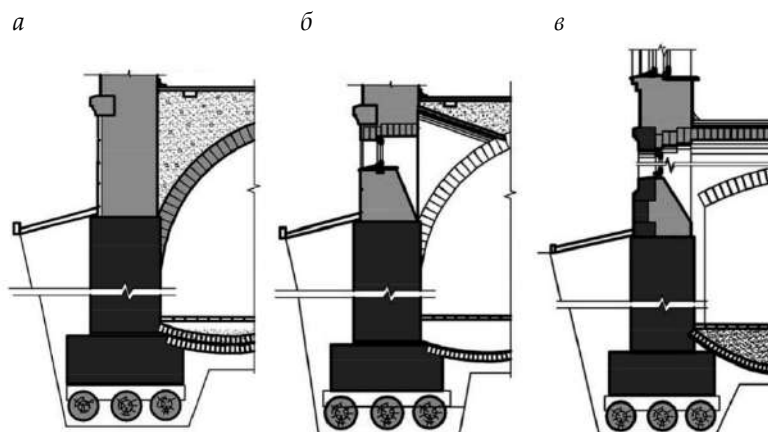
Надподвальные перекрытия: а – с цилиндрическим сводом; б – с цилиндрическим сводом распалубками; в – по прусским сводам
